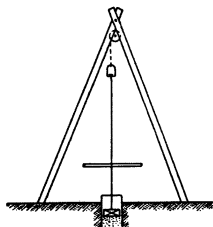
Stampfen von Betonpfählen. (Nach Krüger.)
